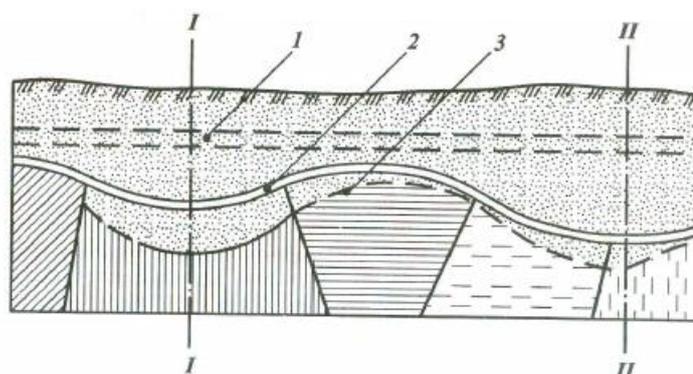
Схема подземного трубопровода в оттаивающем грунте
